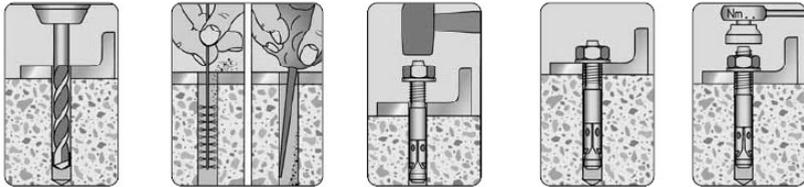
Fijación de las columnas de espejos deflectores UMC y, en caso dado, de las columnas de fijación UDC
